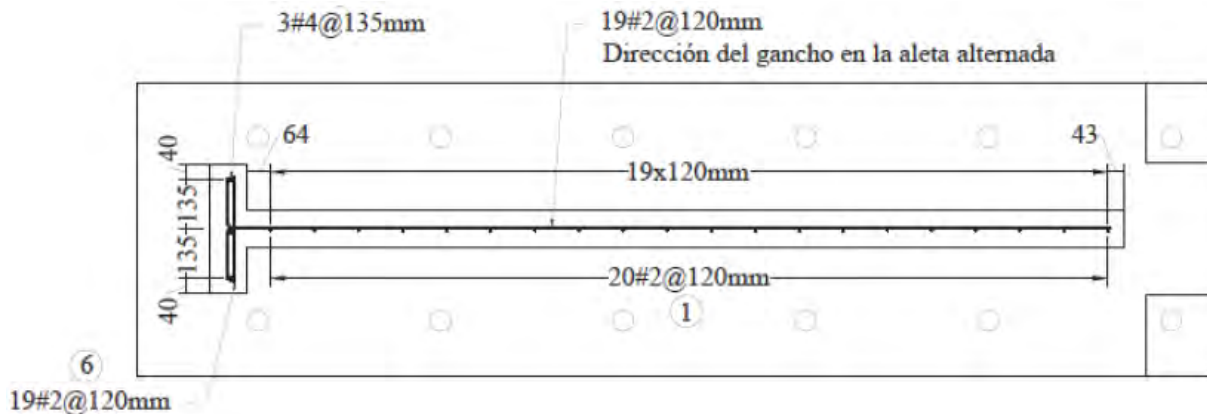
Detalle estructural de muro W4 (CEER, 2017)
